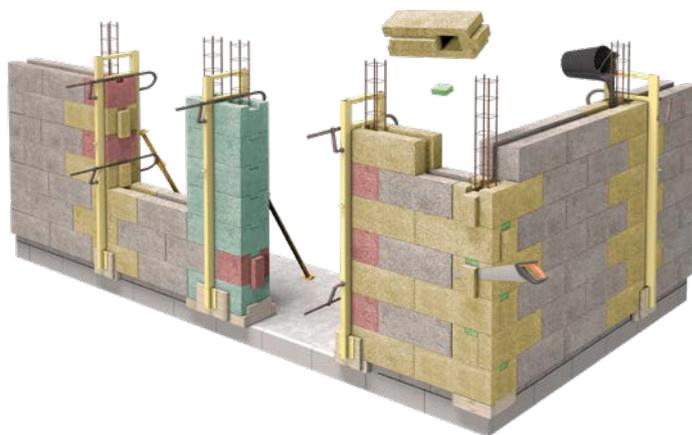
Structure poteaux-poutres en béton armé. Les blocs jouent le rôle de structure et d'isolant (Source : Vicat – Biosys BCE).
